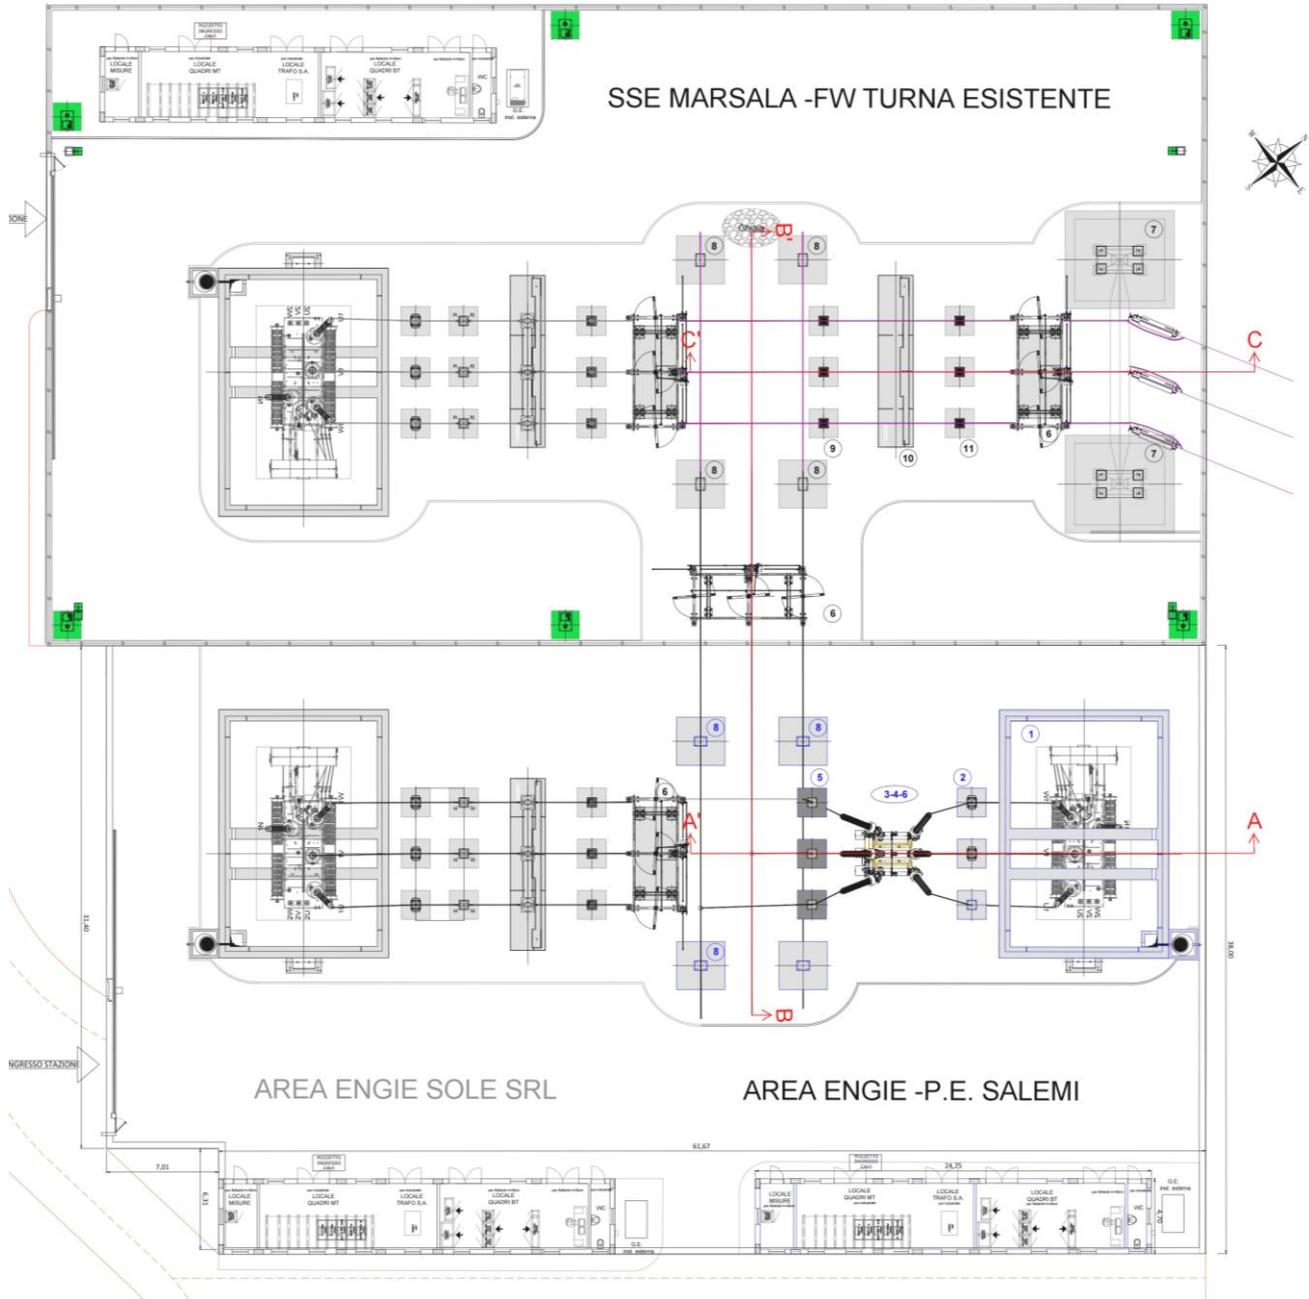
Planimetria apparecchiature elettromeccaniche
